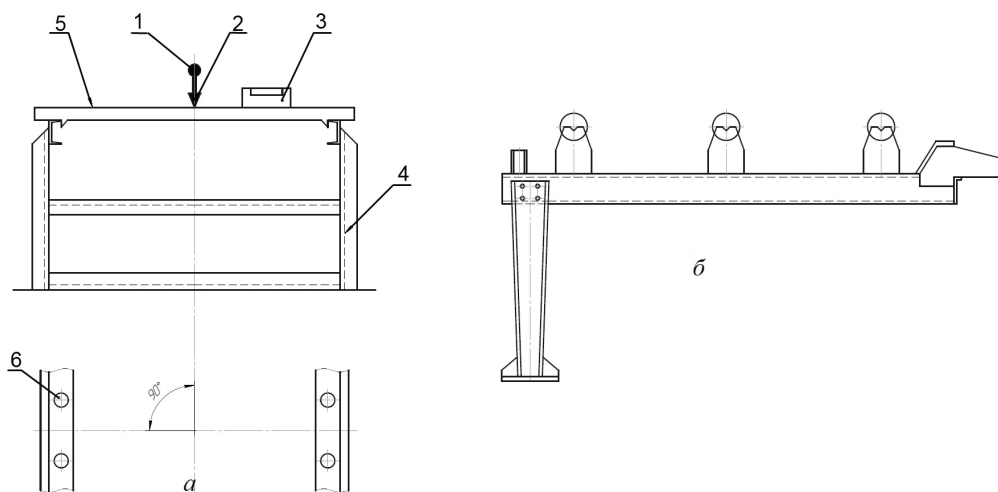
Схема подготовки металлоконструкции к монтажу:
